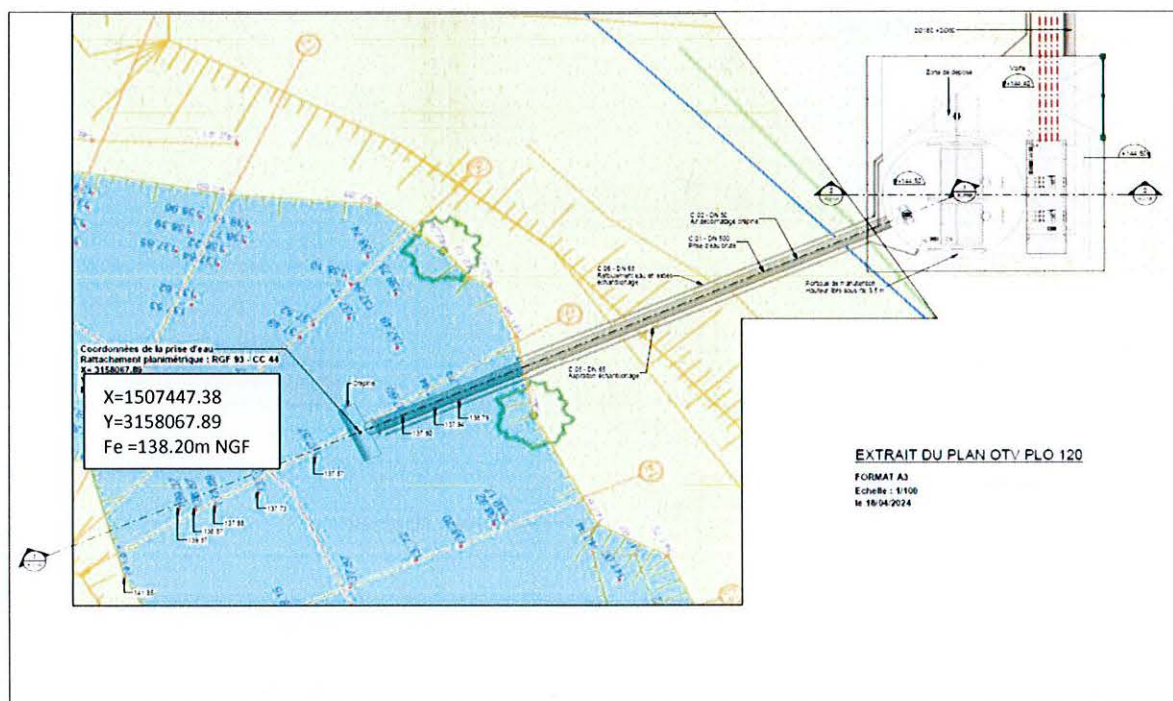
Plan de la station d'exhaure prévue sur le site de Pavie (modifié d'après source : EGIS 18/04/2023)
